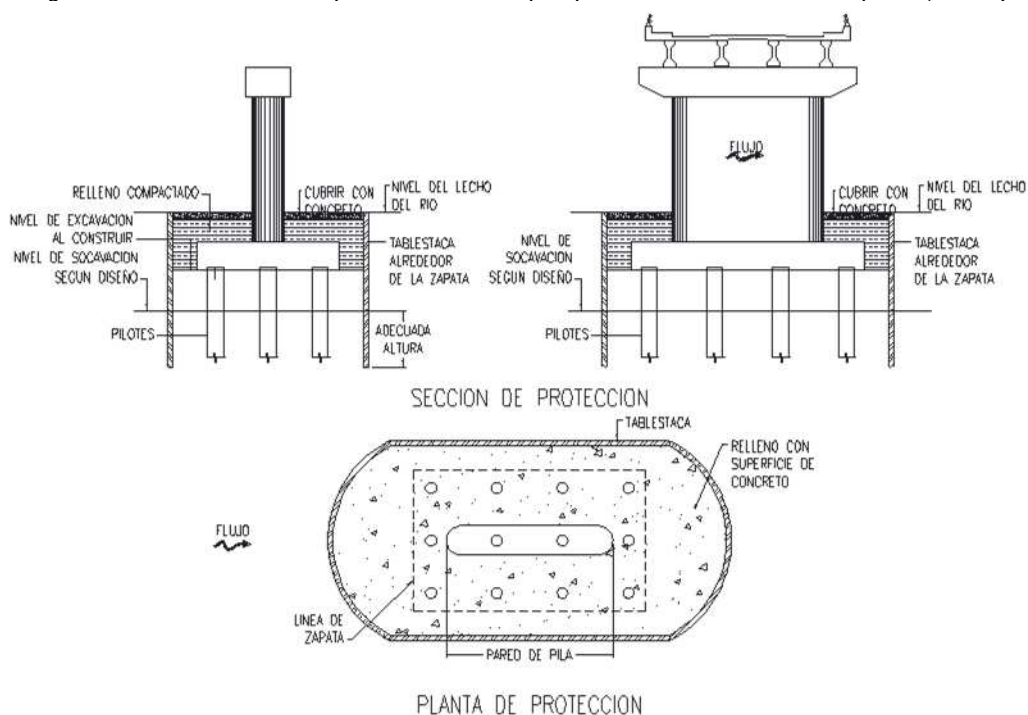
14 Protección local en pilas mediante tablestacas. (SPOP, 2014)
